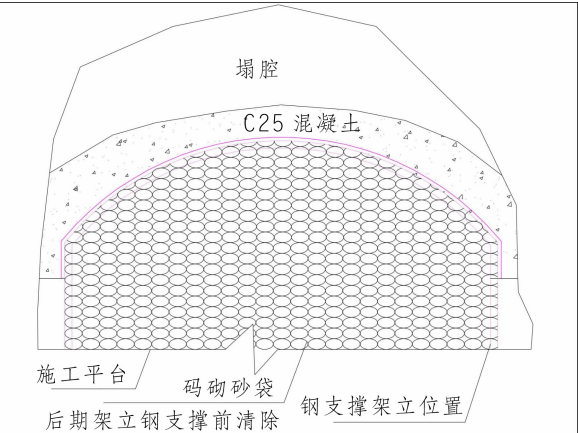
下部空腔采用码砌砂袋作为顶拱混凝土支撑示意图
